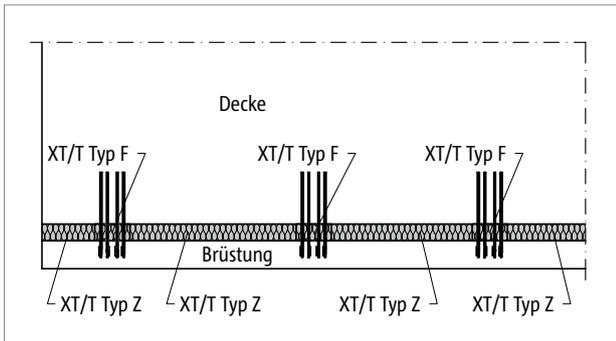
Schöck Isokorb® XT/T Typ F, Z: Frontal angeschlossene Brüstung
